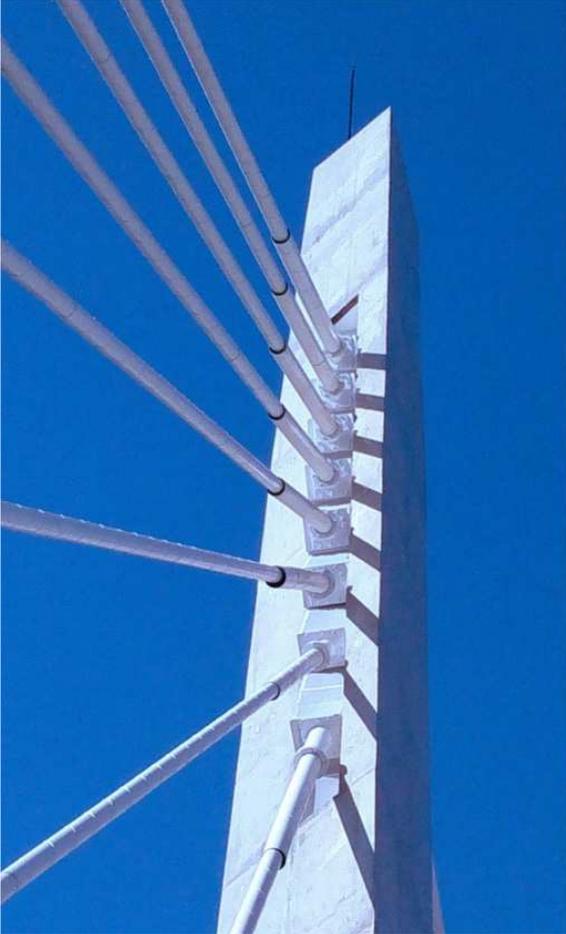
Antenna ed ancoraggi degli stralli / Tower and Cable Stays anchorage
